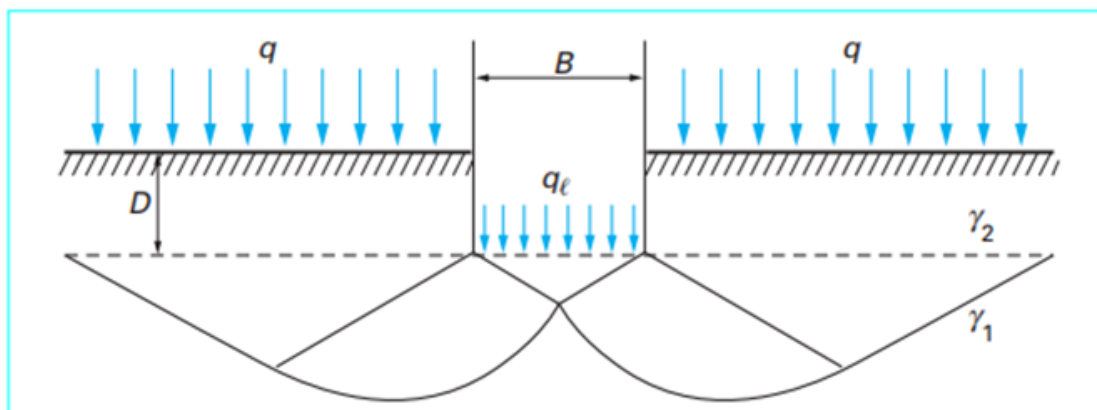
Schéma de rupture d'une fondation superficielle. [8]
